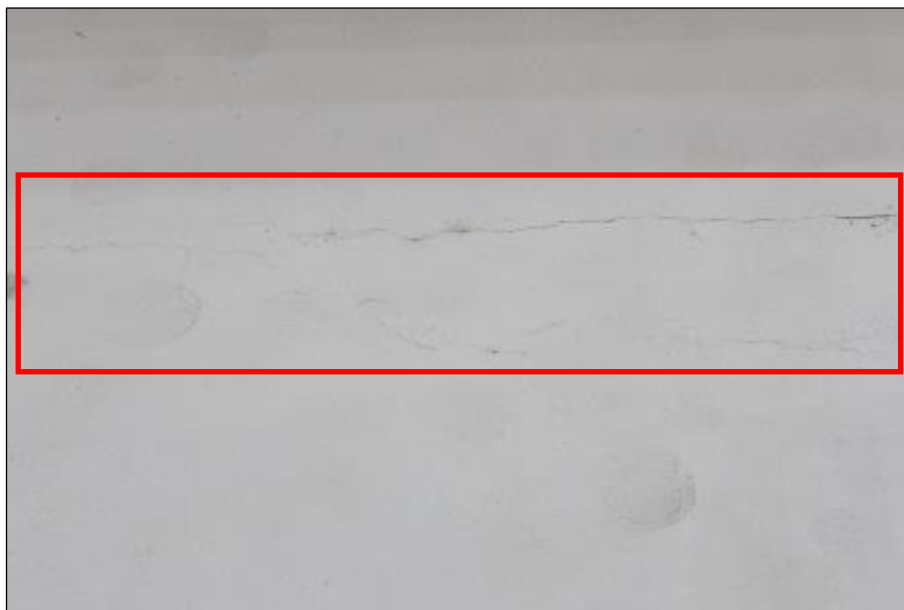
Fissura horizontal na face externa da alvenaria.
